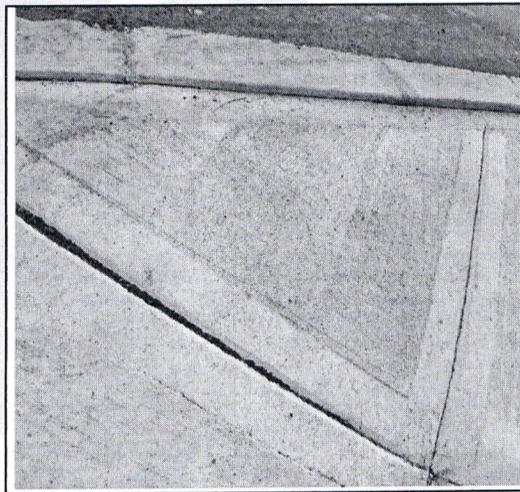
Fisura plazoleta escenario atletismo
